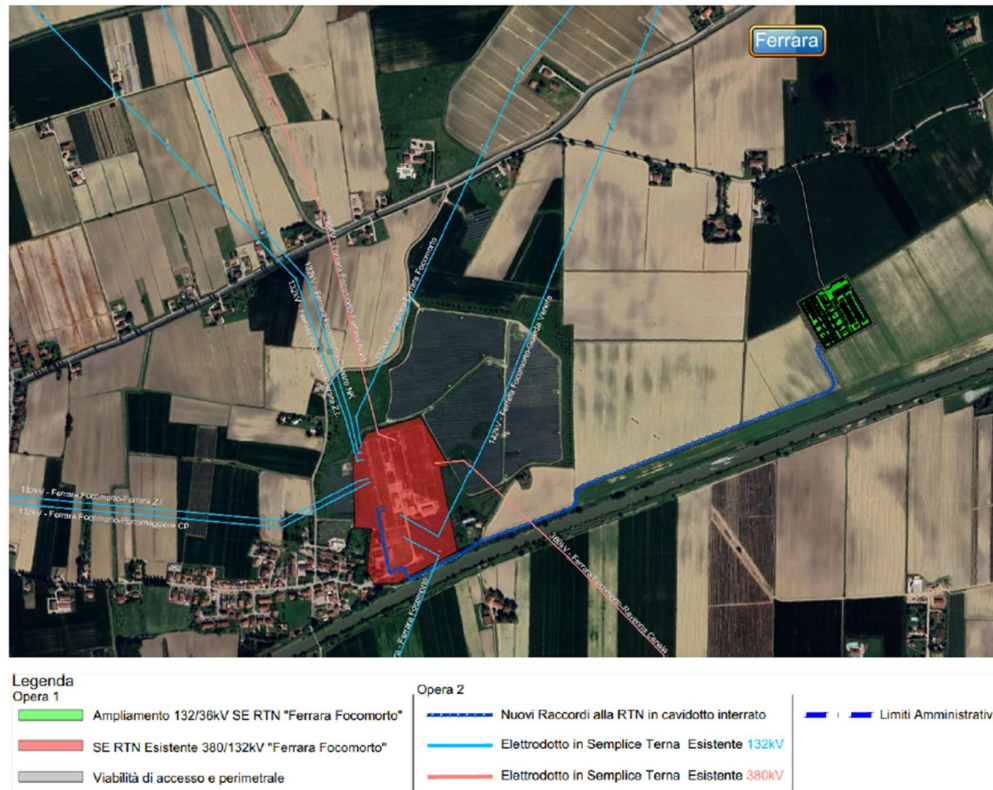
Sviluppo planimetrico territoriale delle opere in progetto
